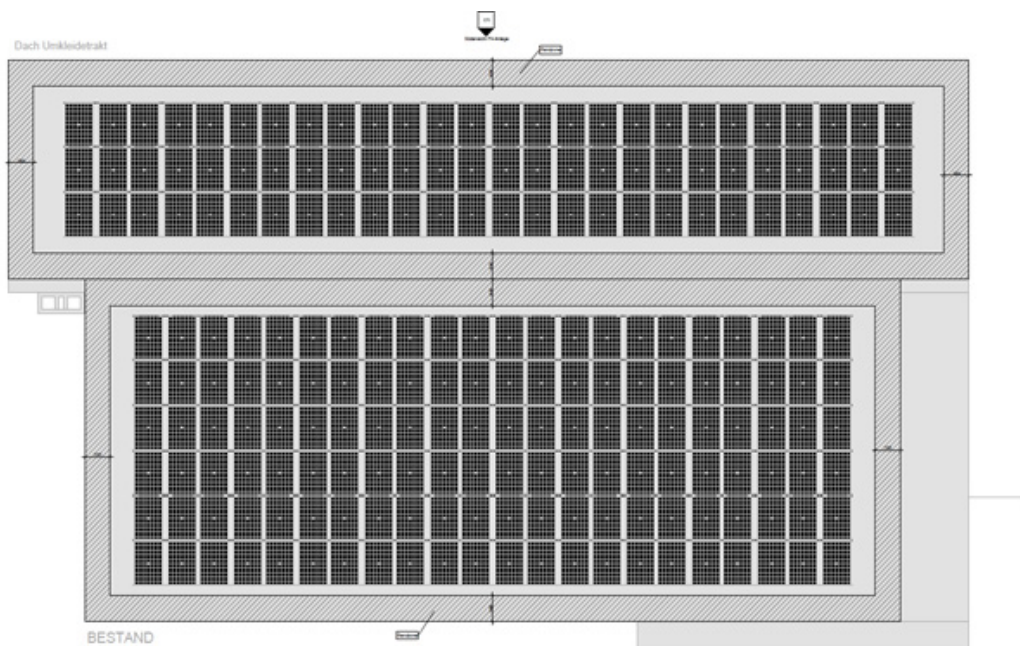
Draufsicht Bestandsdach mit PV-Anlage; Planungsbüro Käppel⁵
